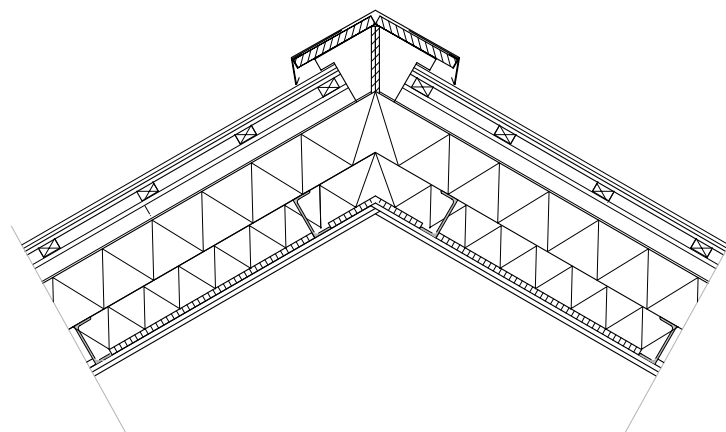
Schnitt Dachfirst mit Firsttrennung, M. 1:20
